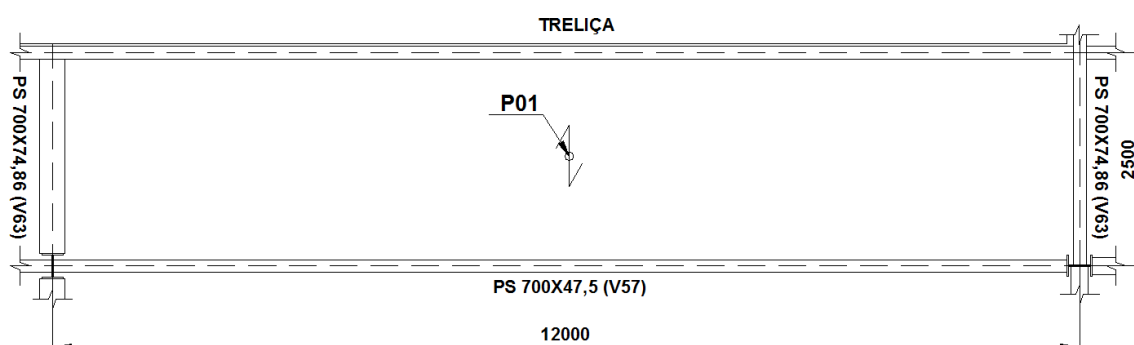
Plano das vigas da região 4 com o posicionamento do acelerômetro.
